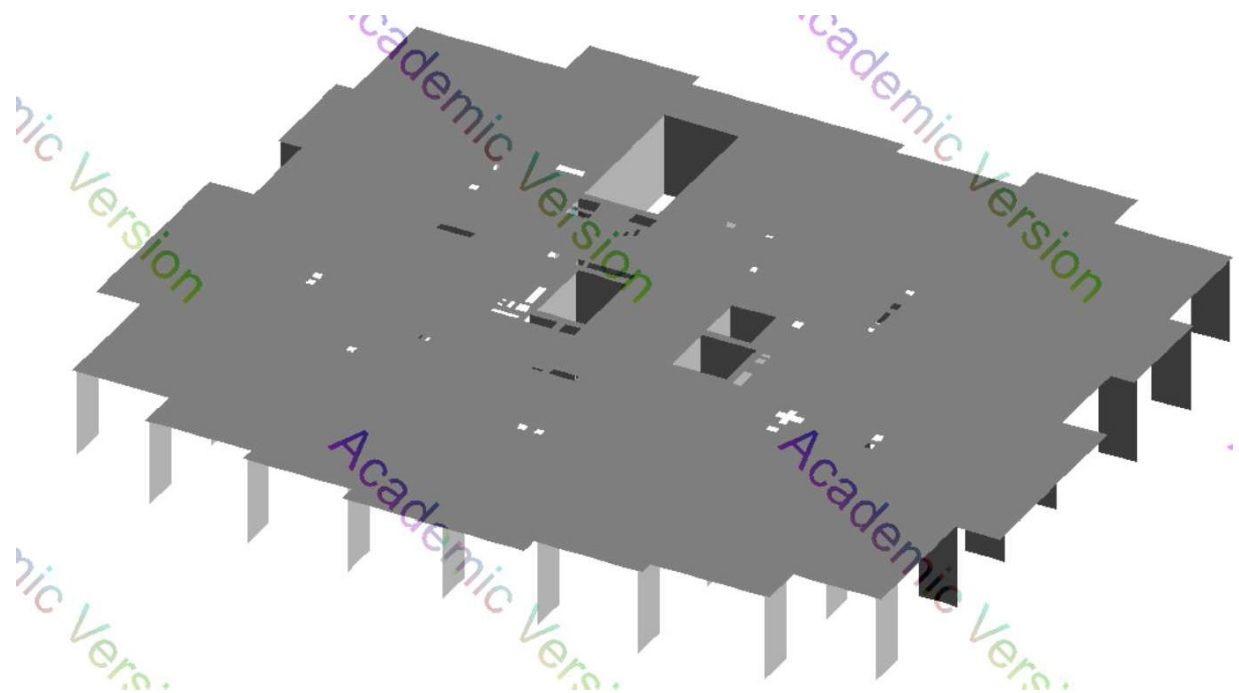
Фрагмент схеми типового поверху будинку ЖК «Атлант»
